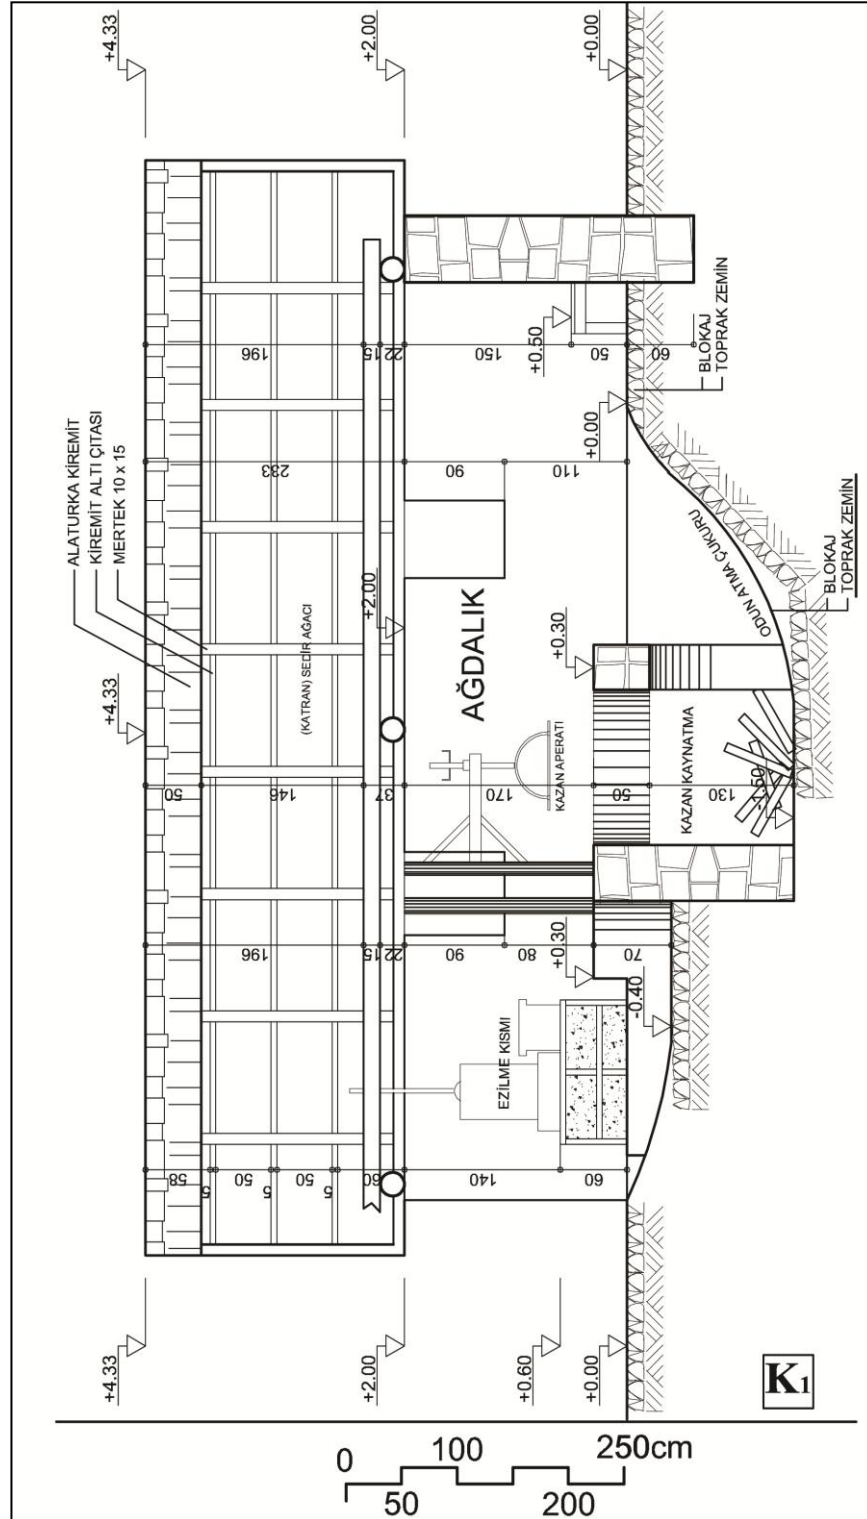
72. Bozhöyük (Semahöyük) Köyü ağdalık yapısı rölovesi, vaziyet planı (V)
